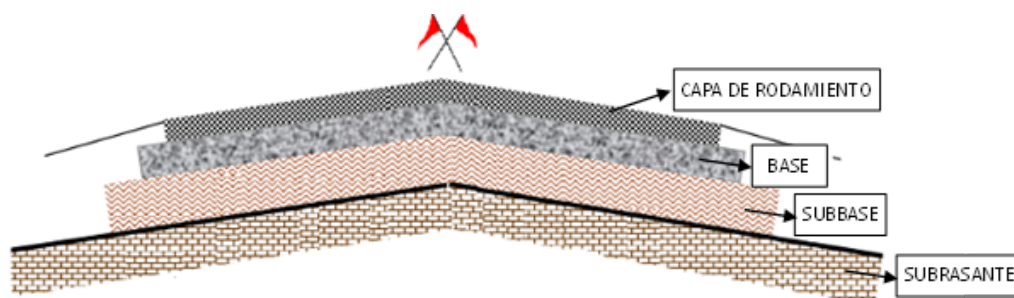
Perfil típico de las capas de un pavimento flexible. Fuente: material de apoyo de la cátedra Transporte III [8]
